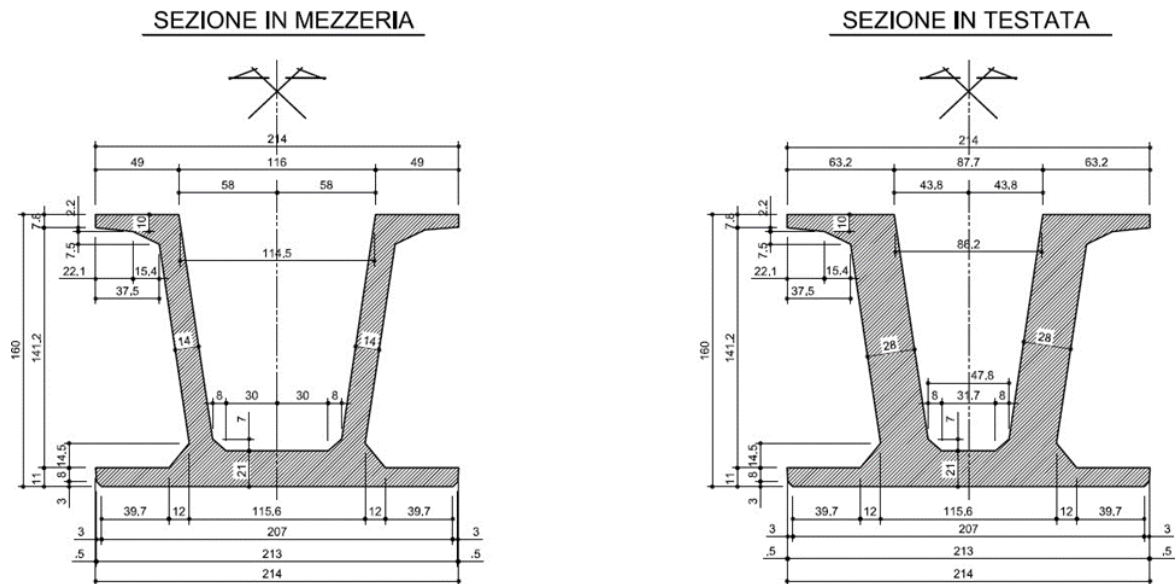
Sezione trasversale trave CIR 214/160/14-28cm
